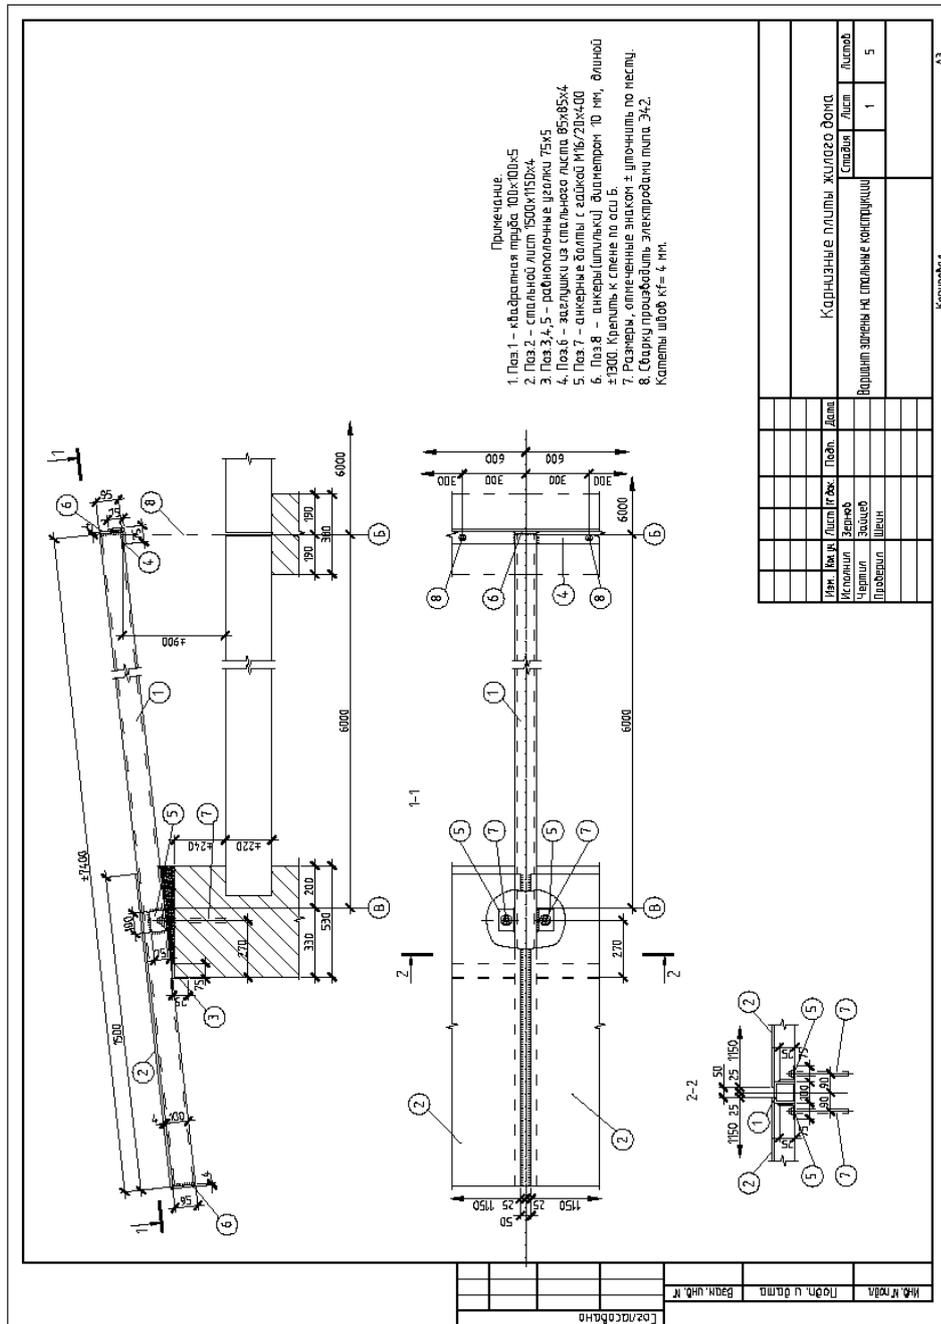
Вариант замены железобетонных карнизных плит металлическими козырьками
